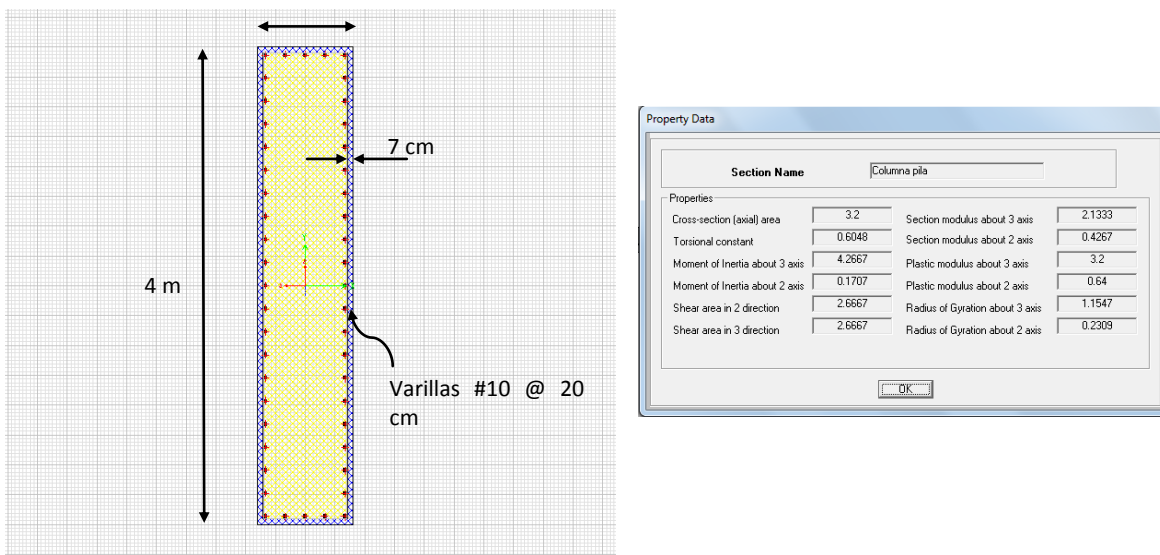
Sección transversal de la pila tipo muro y sus propiedades.
